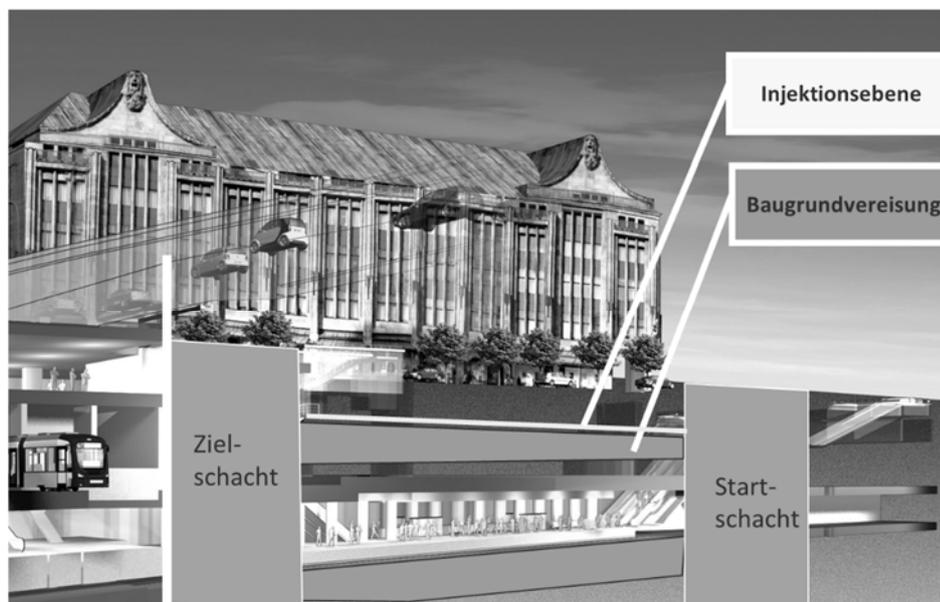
Tunnelvortrieb zwischen Start- und Zielschacht im Schutz einer Baugrundvereisung
